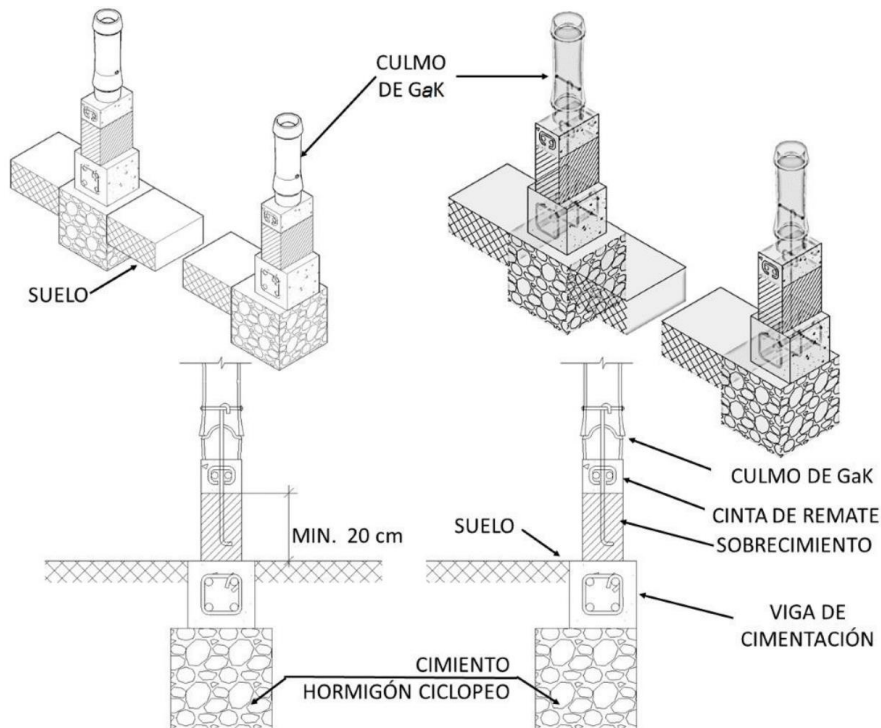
Detalle de apoyo de columnas de GaK en sobrecimiento
